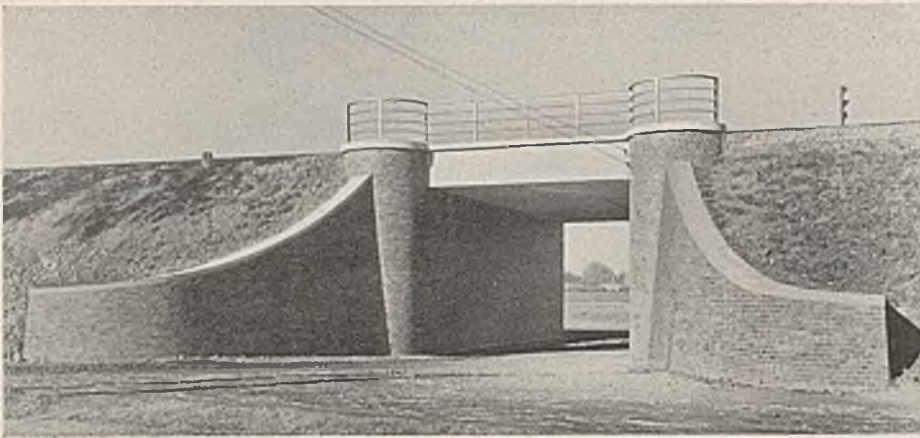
Brücke mit Eisenbetonplattenüberbau und Widerlagern mit schwach geneigten, bogenförmigen Flügeln.
